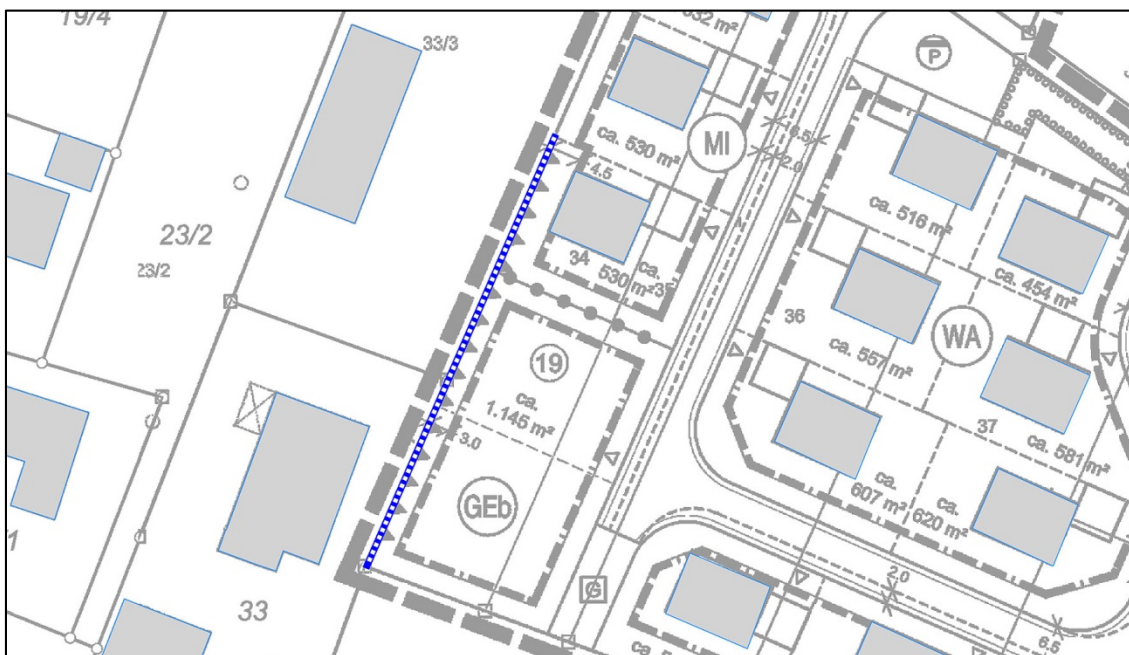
Lageplan mit Darstellung der Lärmschutzanlage
